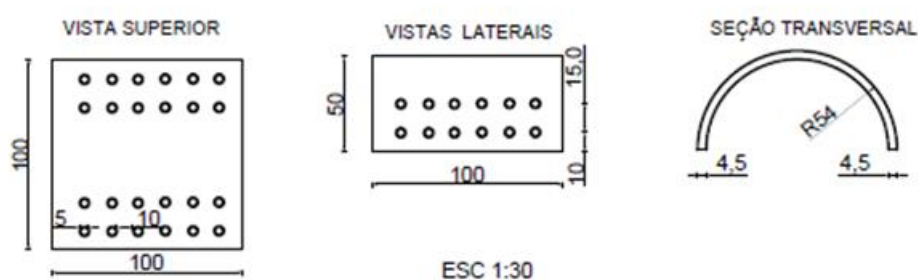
Detalhamento do painel argamassa armada para a câmara de recepção / digestão anaeróbia dos TEvap, dimensões em centímetros.
